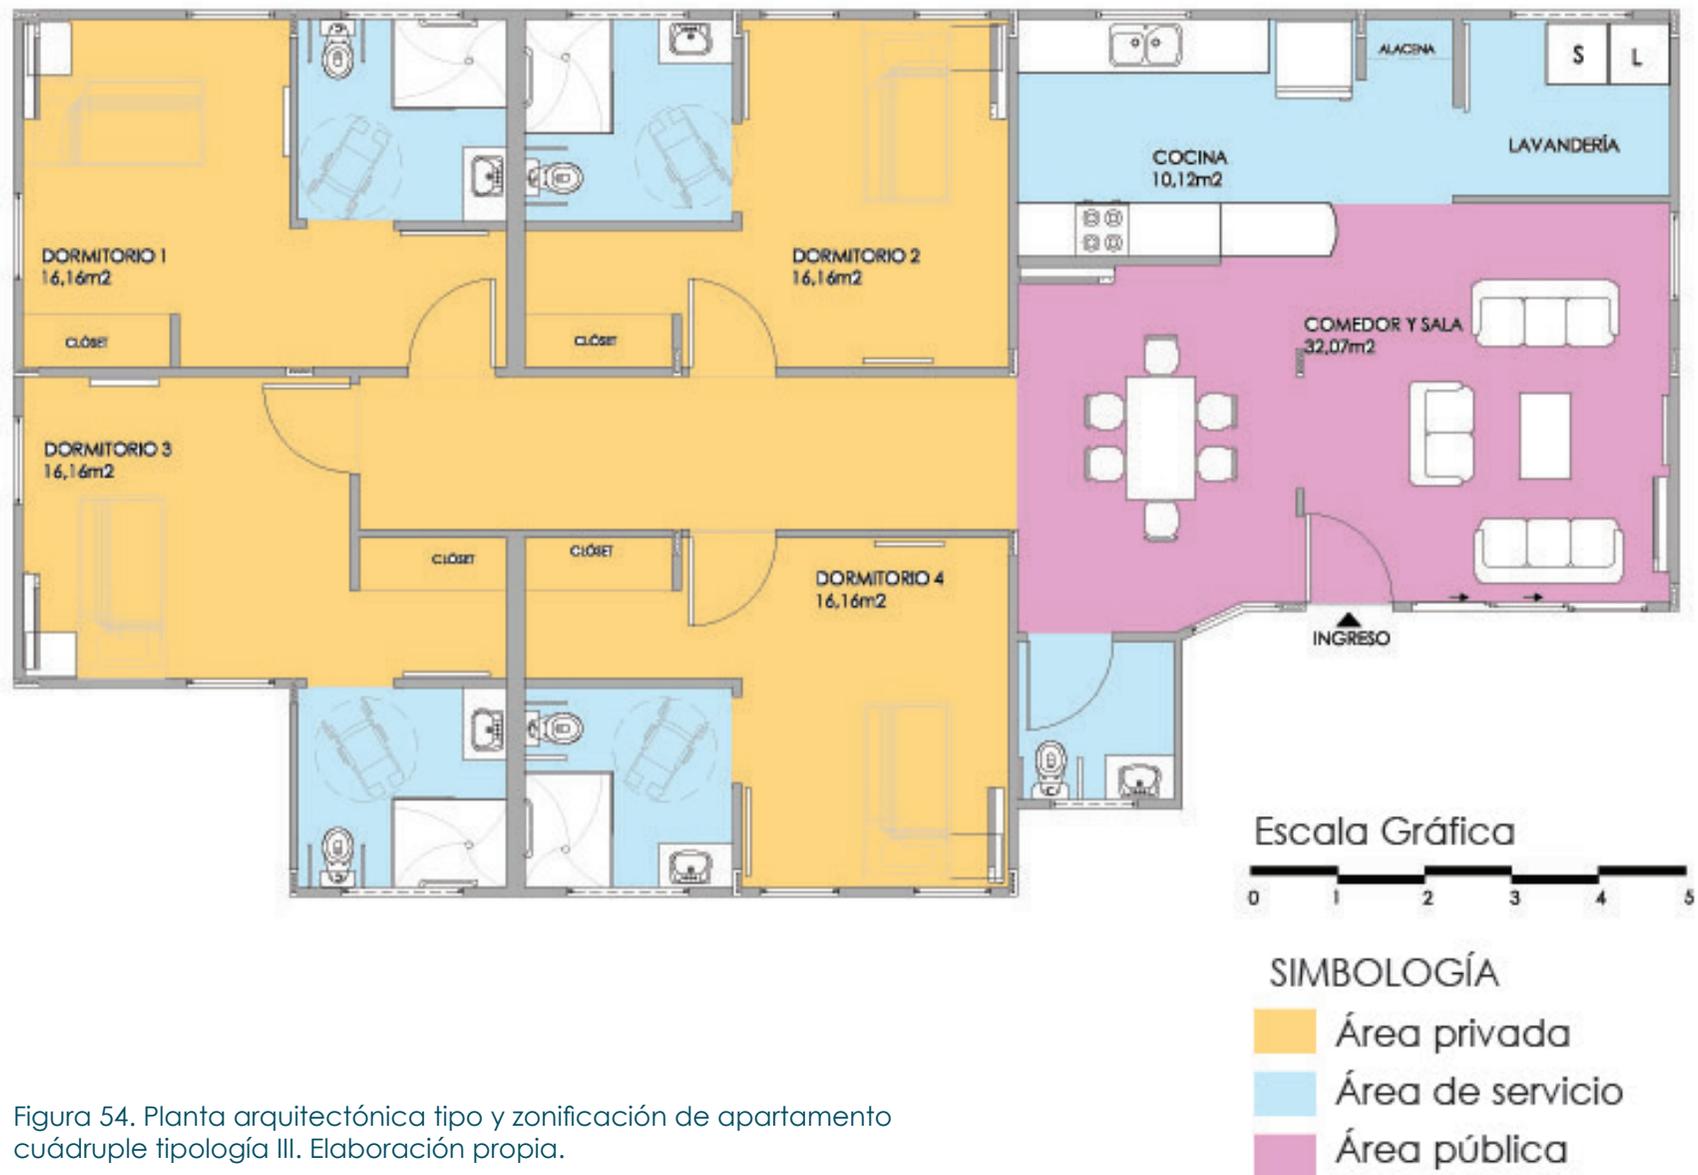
Planta arquitectónica tipo y zonificación de apartamento cuádruple tipología III. Elaboración propia.
